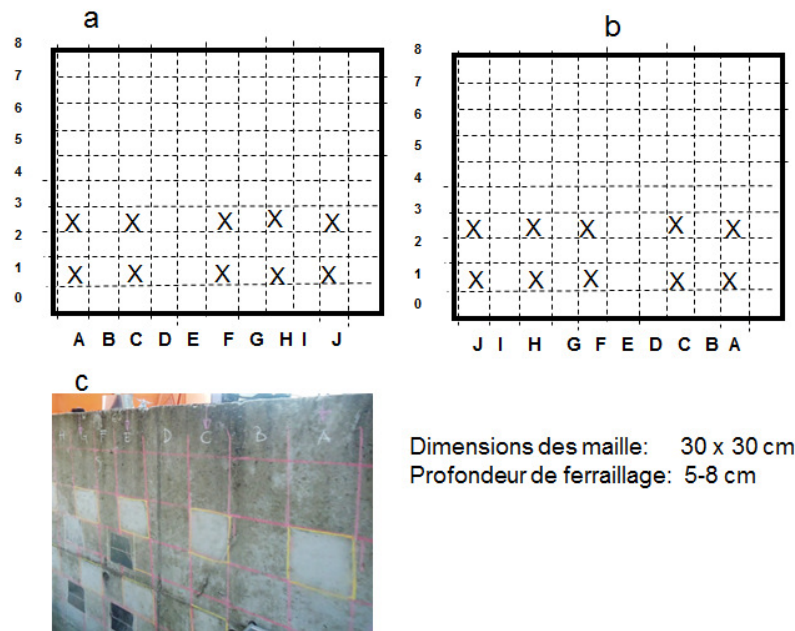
Exemple du plan de repérage (a),(b) ; Plan de ferrailage et les repères sur les deux faces (a) et (b) du même mur (notez que les mailles de même notations se trouvent en vis-à-vis) ;
